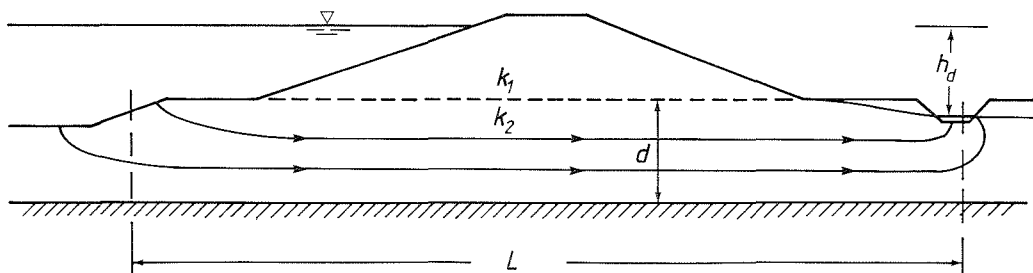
Beteckningar vid beräkning av läckaget genom grunden.
